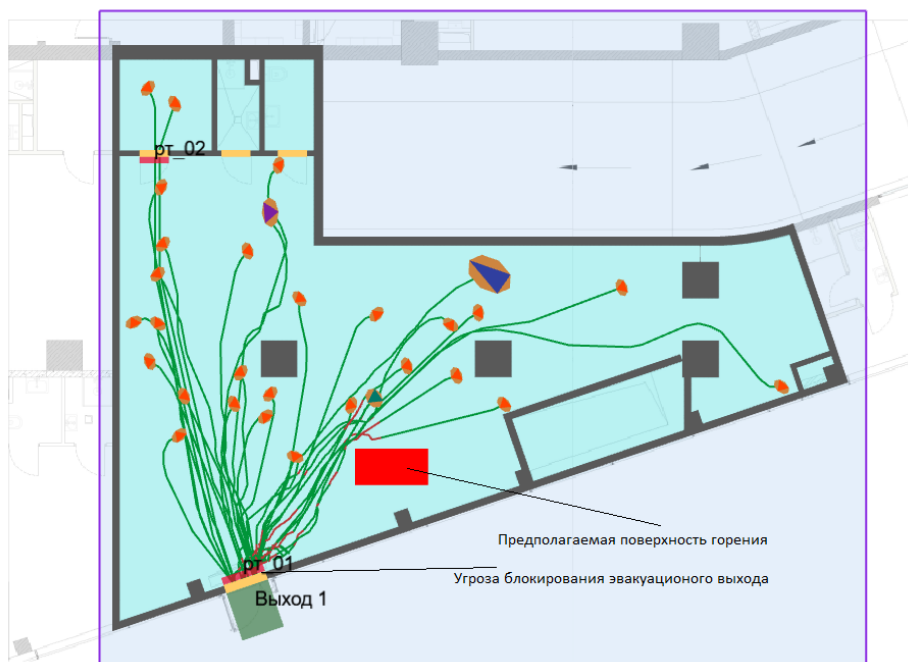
План 1-го этажа и нанесенная на него расчетная (принципиальная) схема эвакуации
